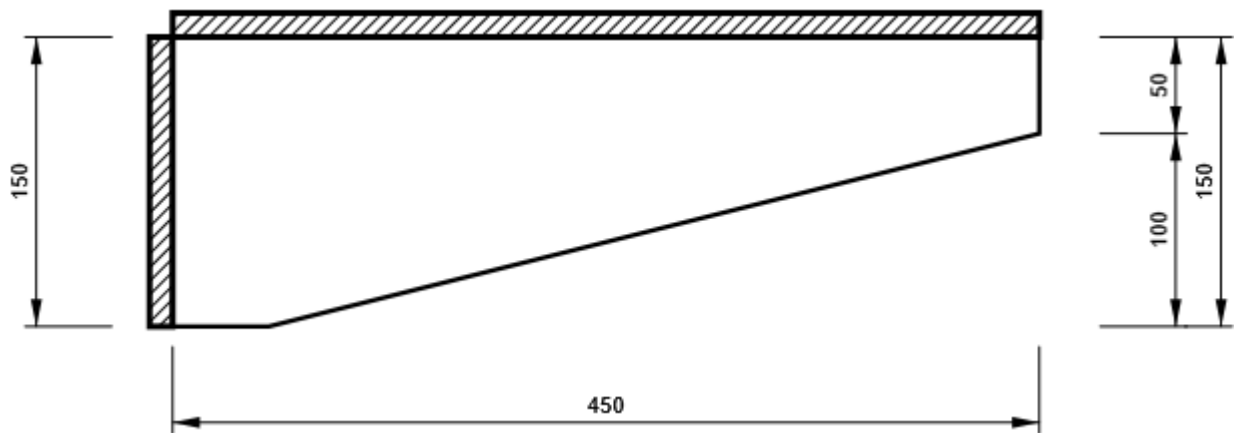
Dimensions et disposition des cordons de soudures sur les renforts de poteaux.
